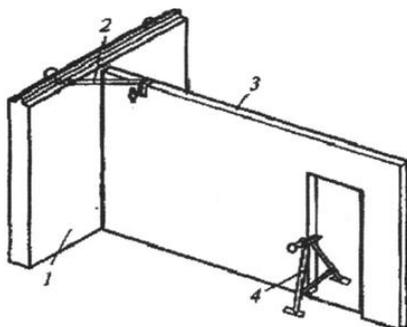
Схема временного крепления панели внутренней стены с помощью монтажной связи и монтажной опоры:
